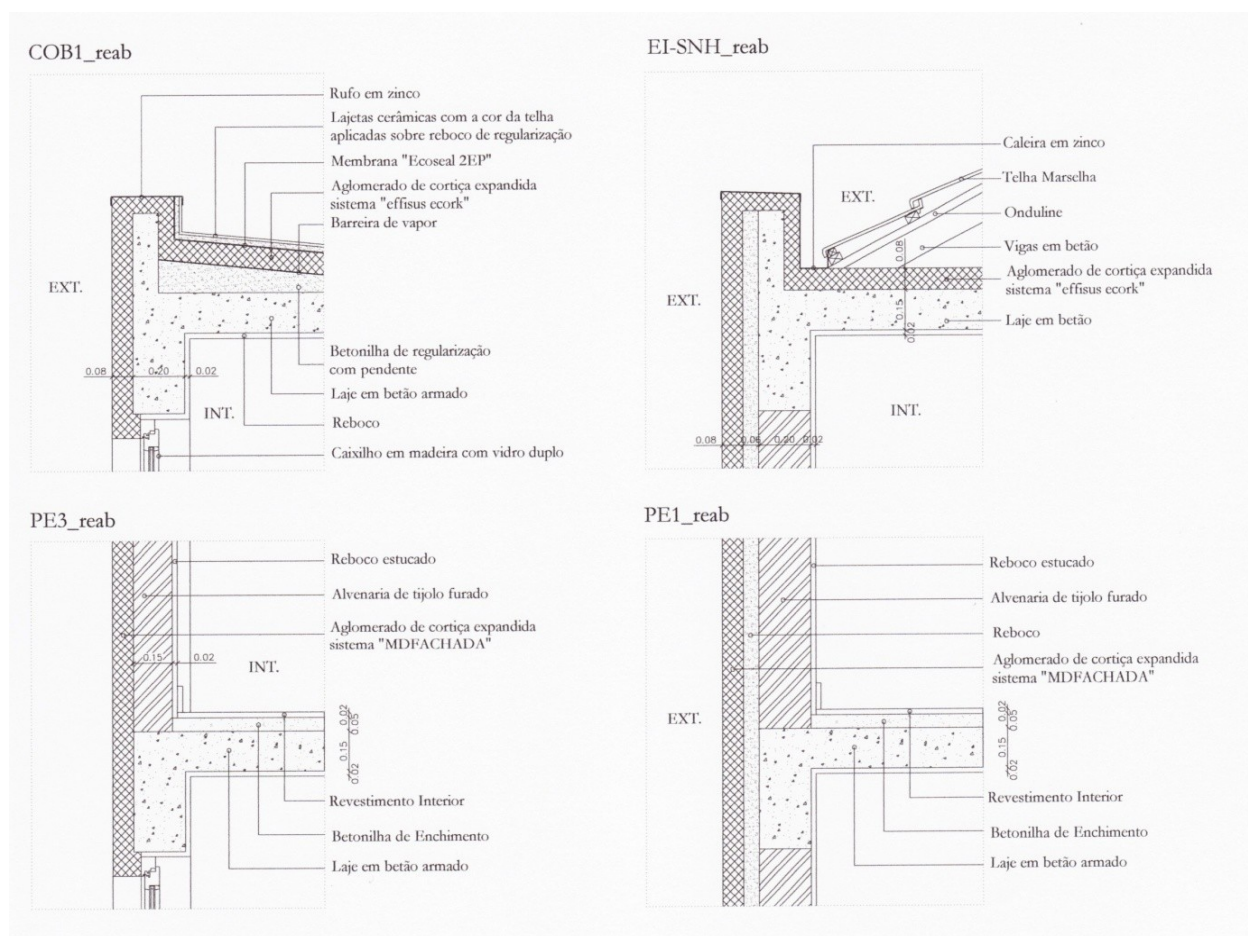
Cortes de fachada do edifício de estudo: situação proposta
